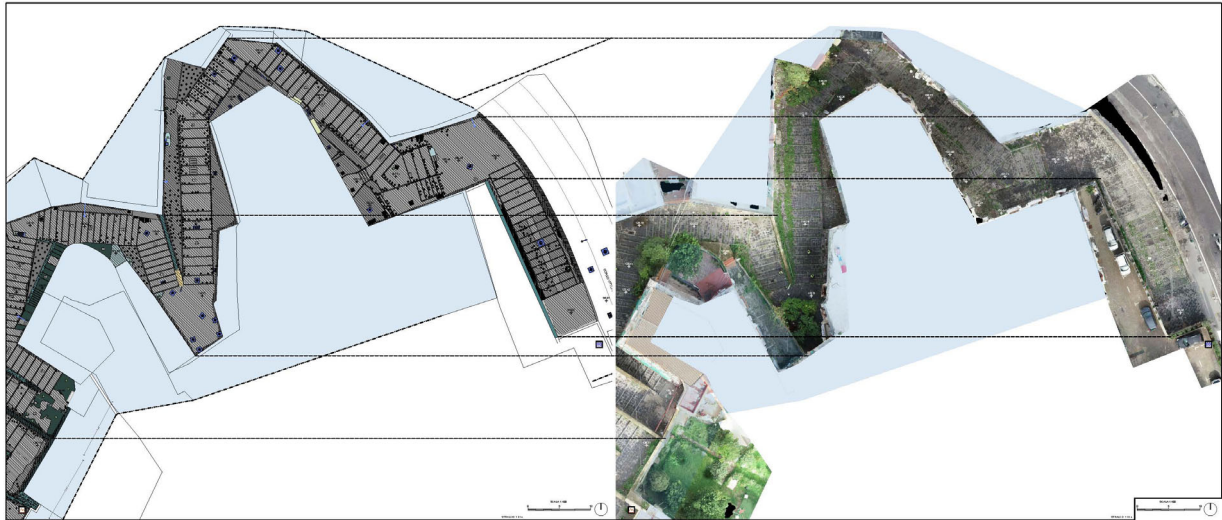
Stralcio elaborato Stato di Conservazione - serie CNAP001GKE - Scala della Pedamentina – Stralcio Planimetrico
